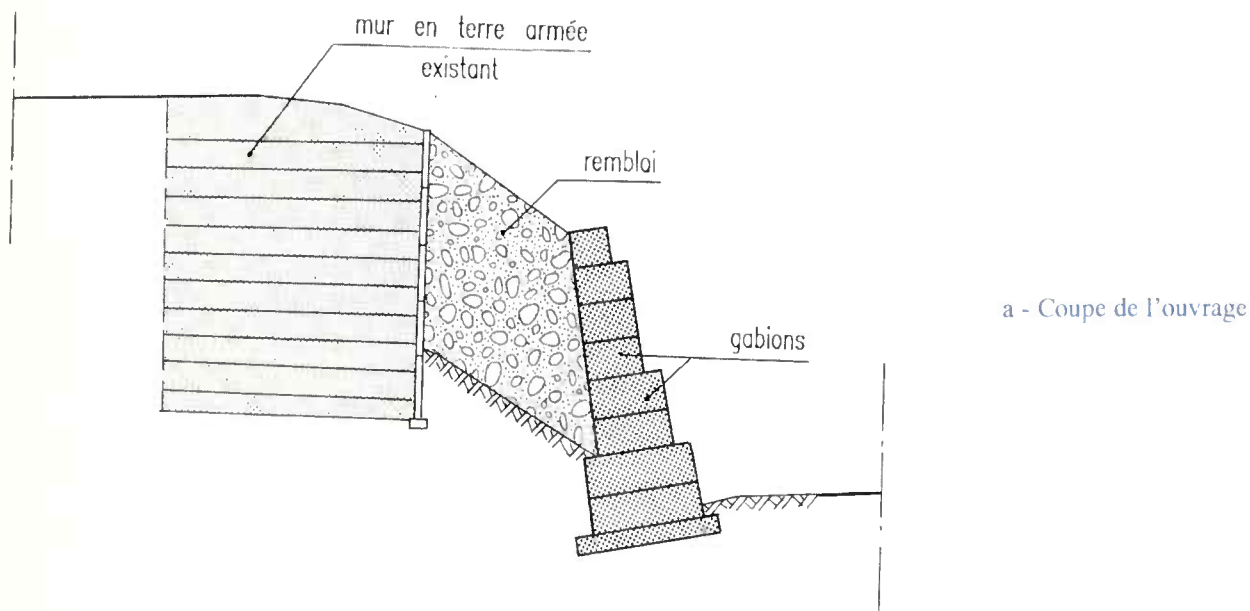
Renforcement par soutènement en éléments préfabriqués
